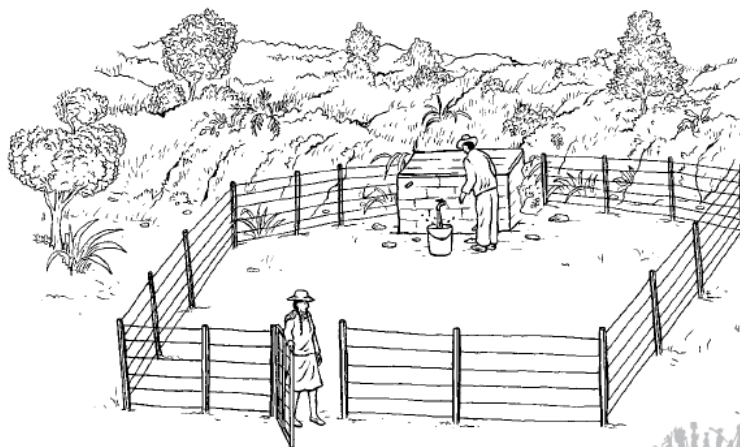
Captación de manantial de ladera concentrado con caja de captación y cercado (Conant & Fadem, 2011).
